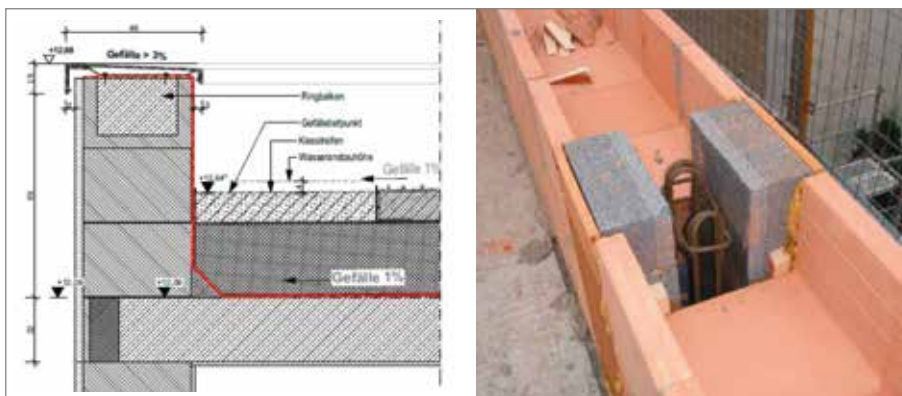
Aus Stellungnahme: Attika aus hochwärmedämmenden Poroton-Planhochlochziegeln mit oberseitigem Stahlbetonringbalken und zugfestem Anschluss an Geschossdecken mittels vertikaler Stahlbetonstützen, OTH Regensburg, Prof. Dr.-Ing. Detleff Schermer, 11-2018
